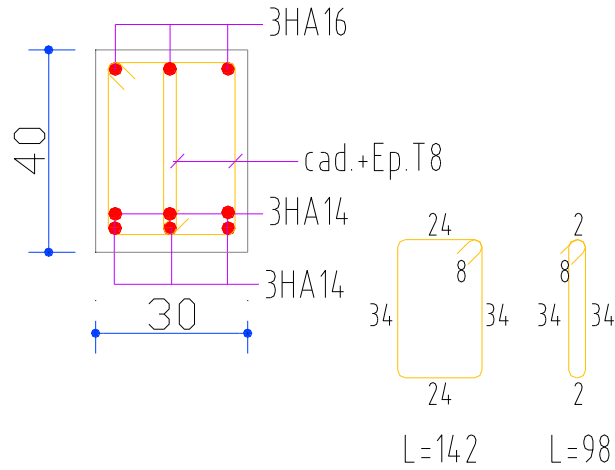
Ferrailage des poutres principales au niveau de travée de 8^{ème} et 11^{ème} étage.
